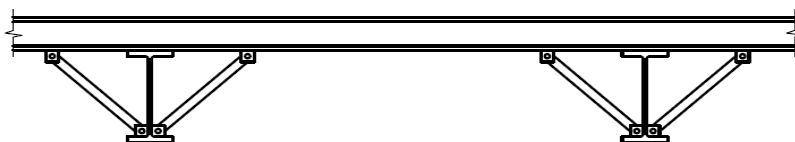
Travamento do banço inferior das travessas e pilares [11]
